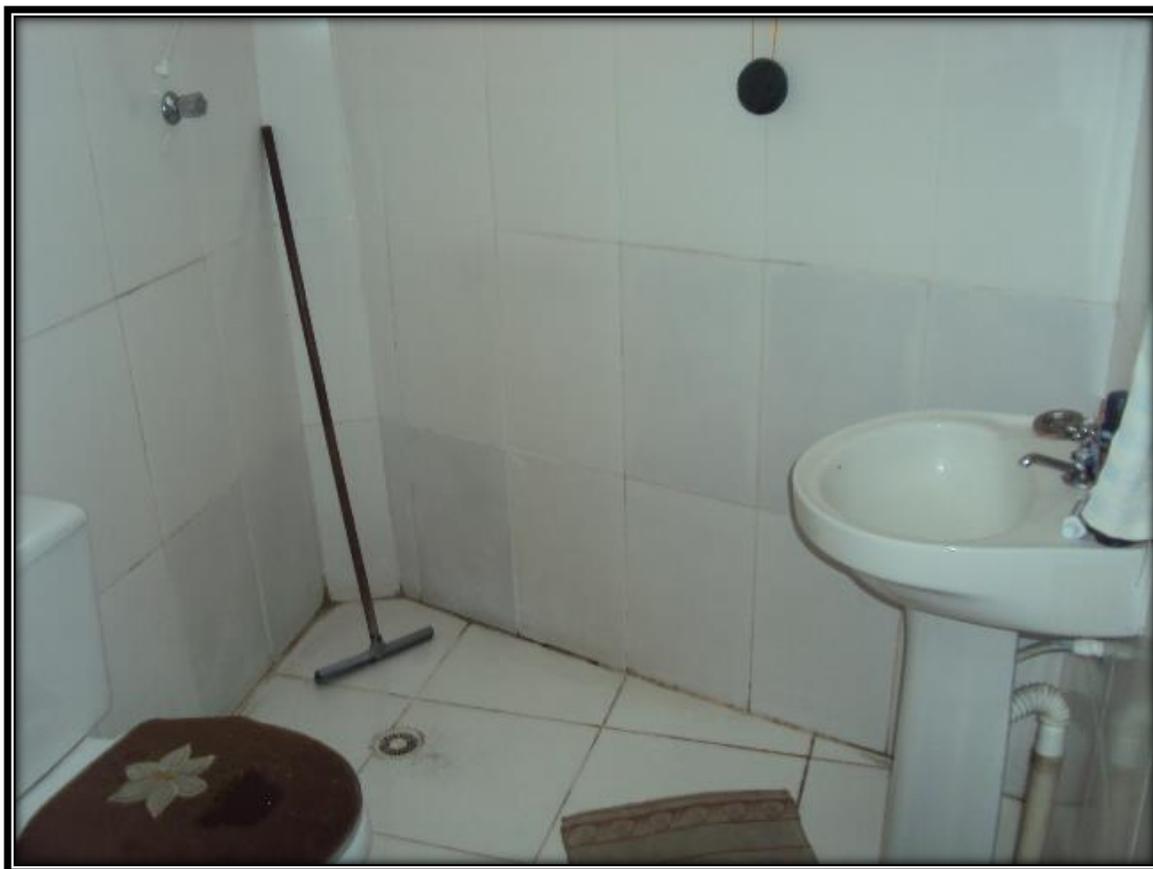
Vista do banheiro do apartamento do subsolo.
